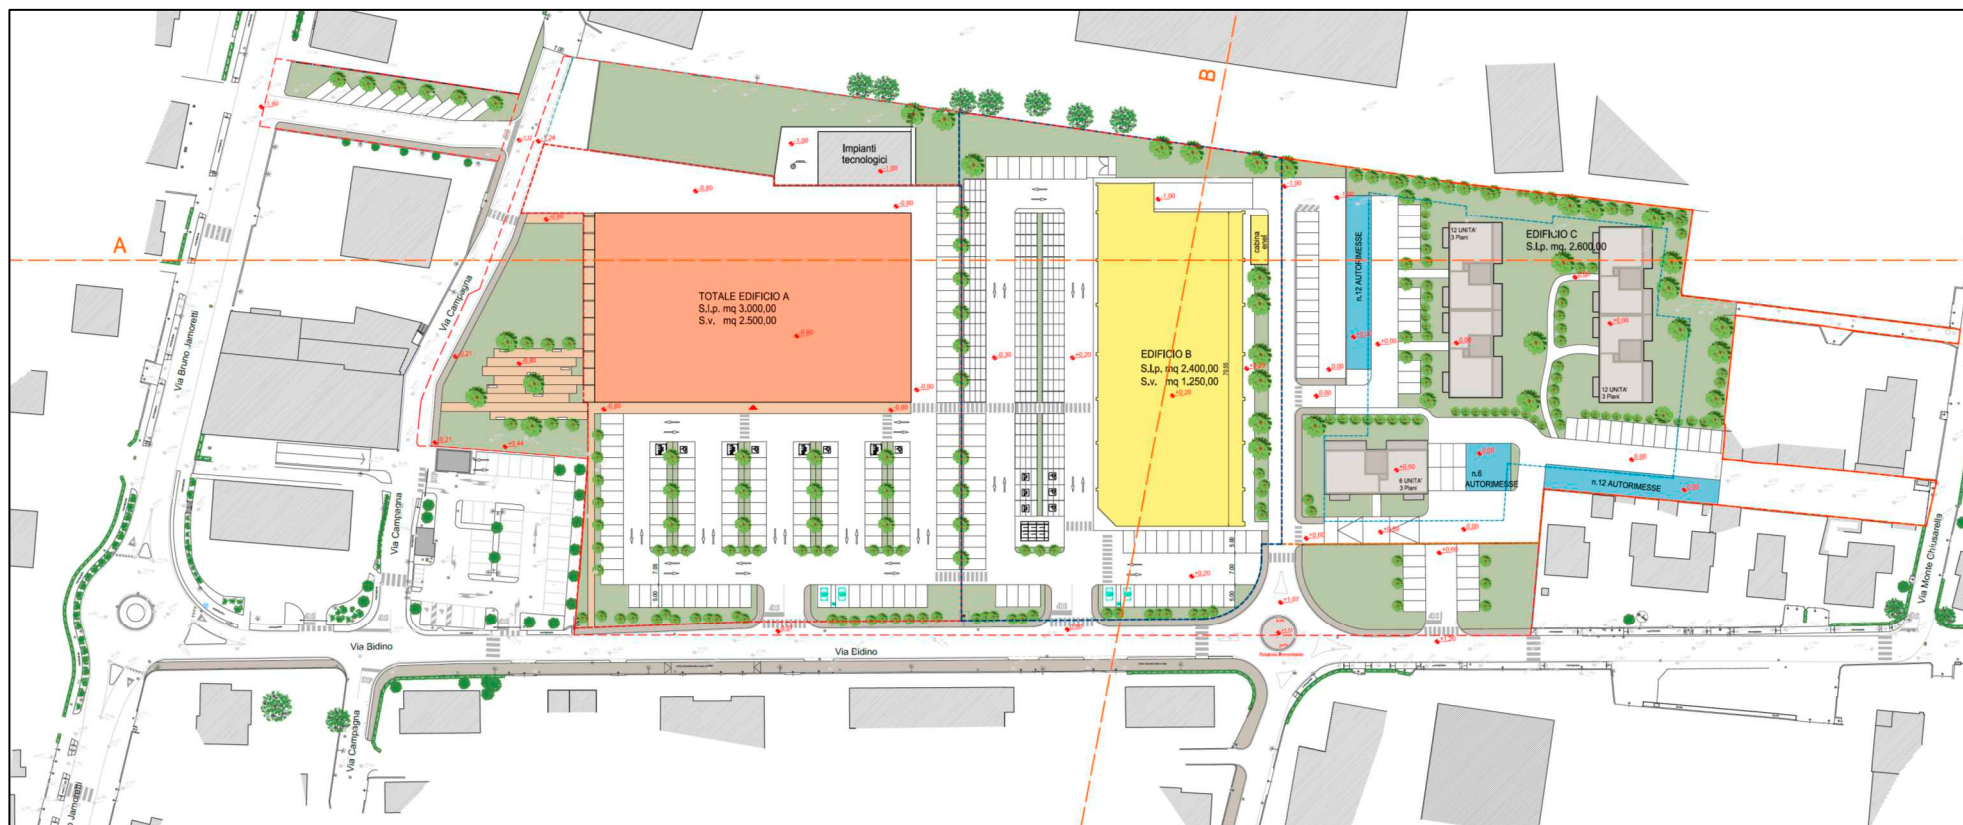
Estratto planimetria generale di progetto.
